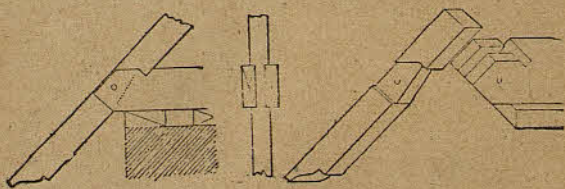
Acoplamiento del tirante y la zapata y ensamblaje de estas piezas con el par por medio de un estribo de hierro.
